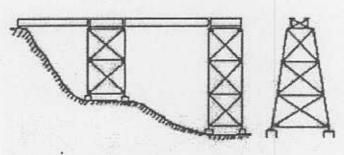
สะพาน Reinforced Concrete Slab (RS)
